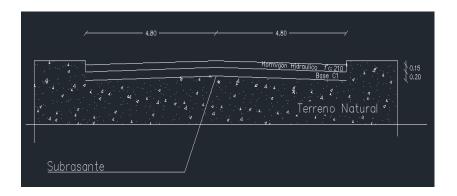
Sección típica de pavimento rígido Fuente: Elaborado por los autores
